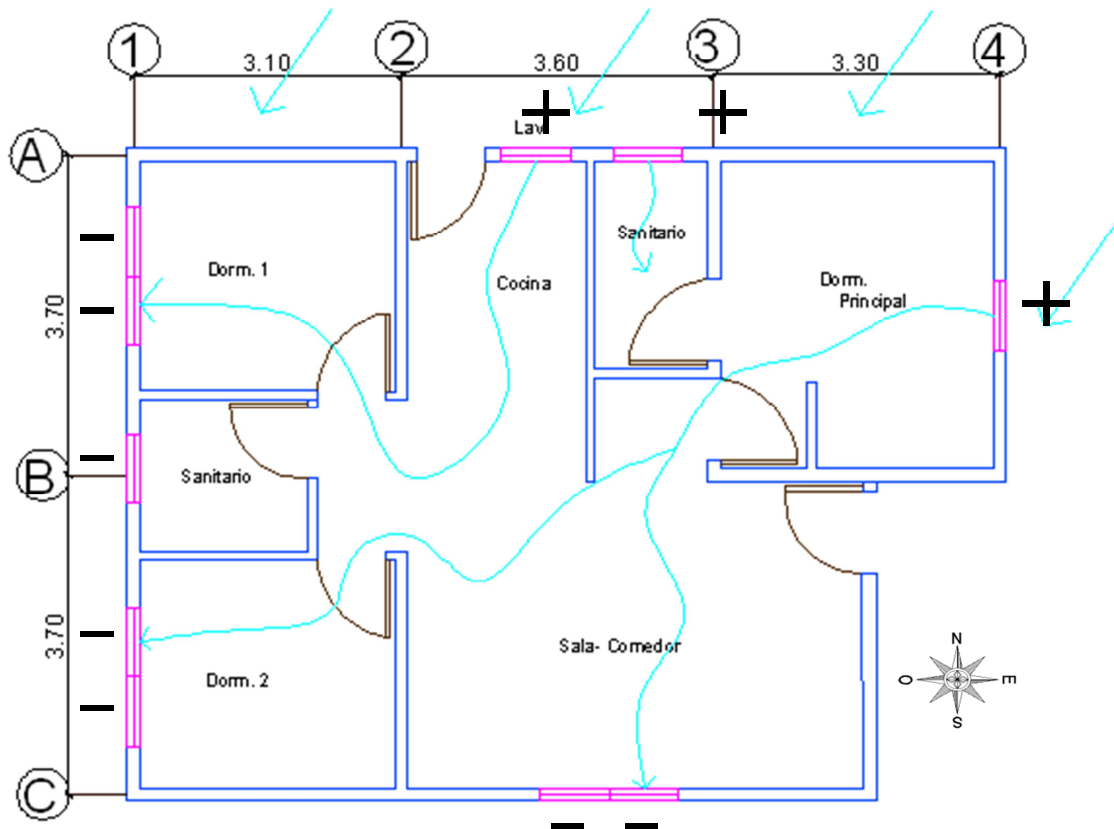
Ventilación cruzada en planta modelo 1 Petrocasa
